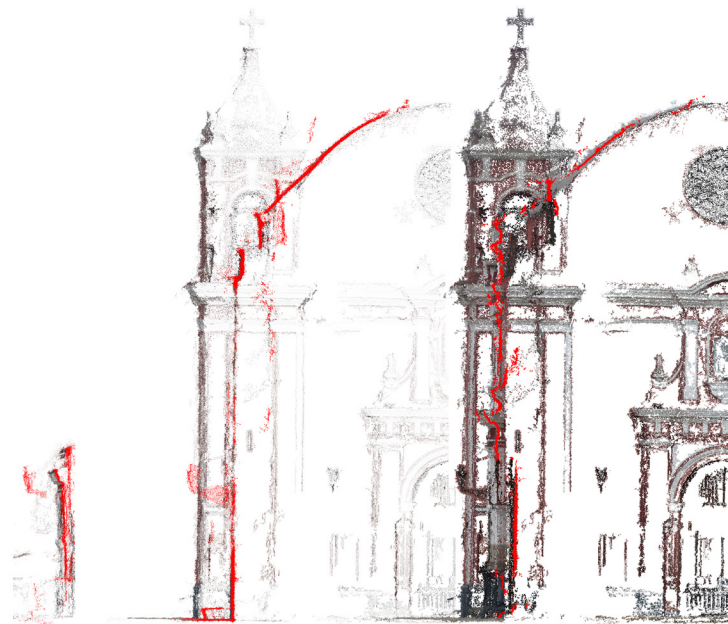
Ortoimagen, corte longitudinal del muro, nave de la Iglesia Santa Ana
